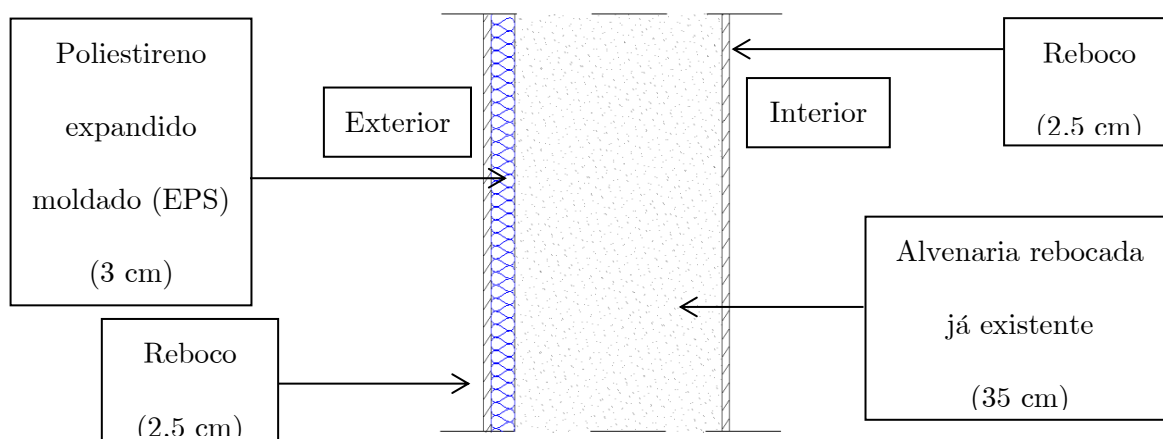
Pormenor construtivo das paredes exteriores (N<sub>2</sub>)
